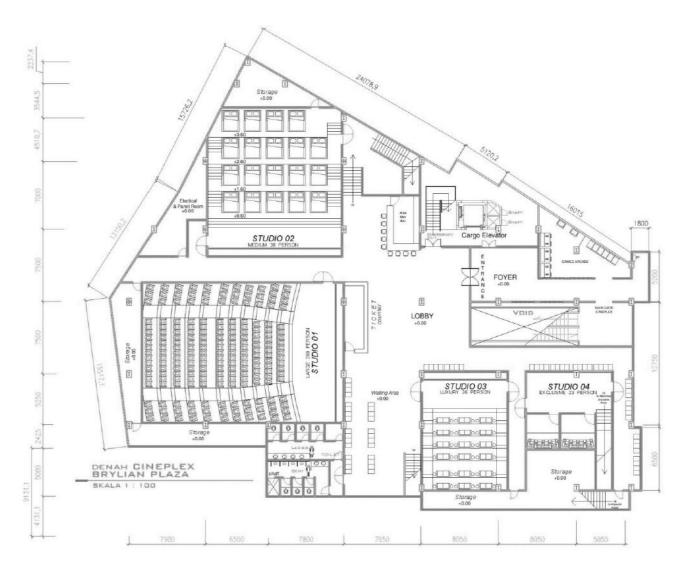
Alternatif 1 Layout Denah – Sinepleks Brylian Plaza Kendari (Mezanine Floor)
